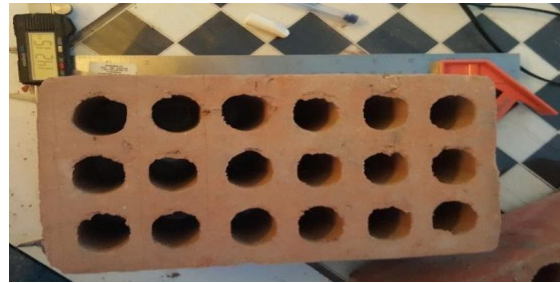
Ladrillera Presentado por la Ladrillera Latesa
